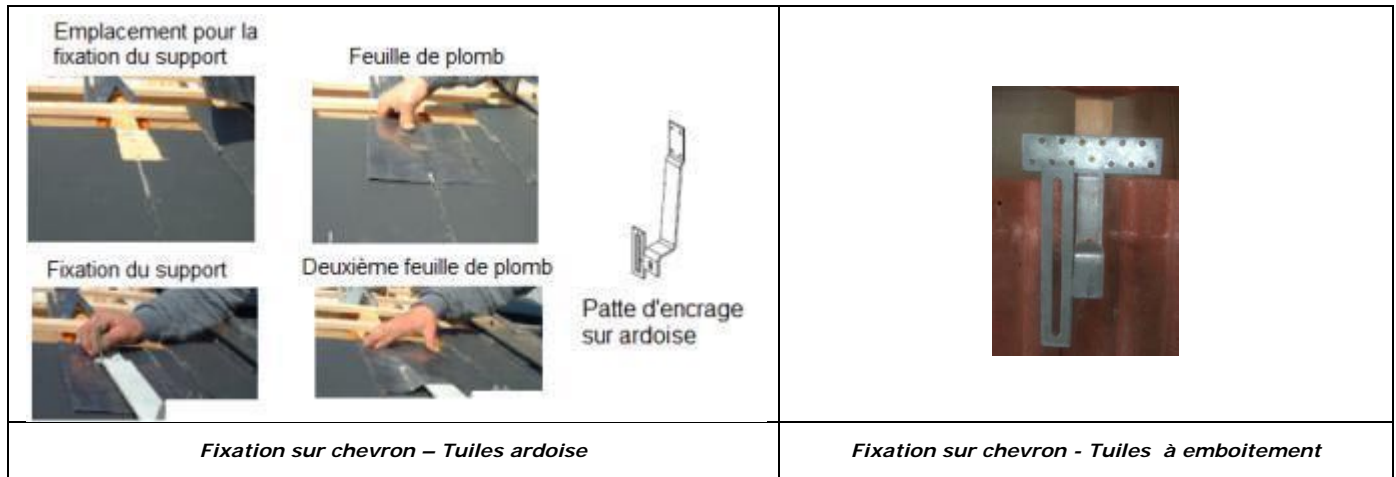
Détail de mise en œuvre sur tuiles ardoise et sur tuiles à emboitement
